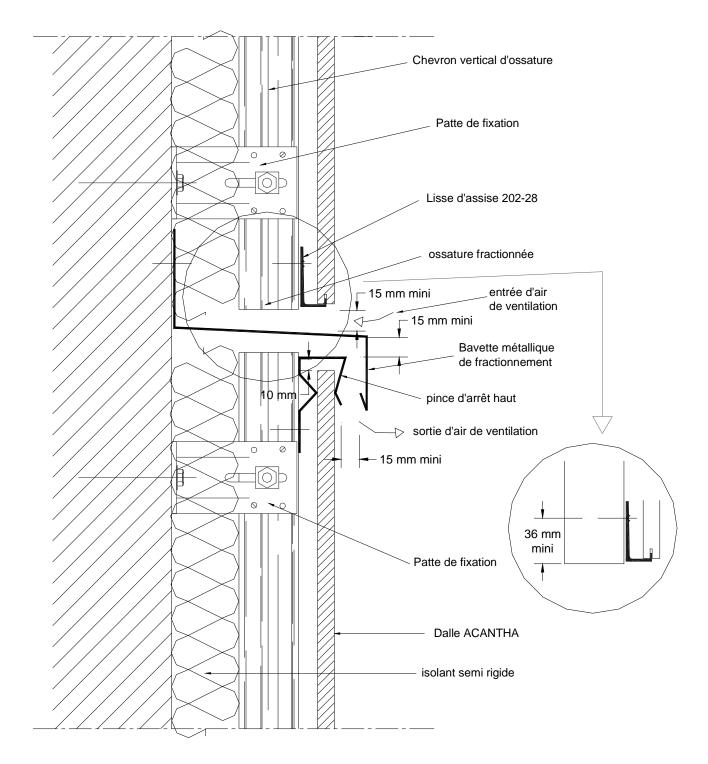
Joint horizontal de fractionnement de la lame d'air (tous les 8 niveaux ou 24 mètres)
